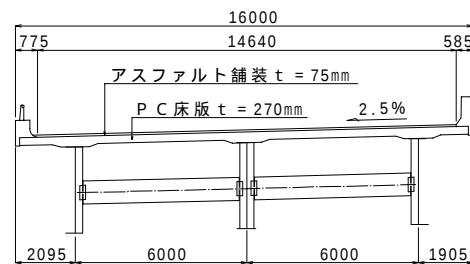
鋼少数鉋桁(3 主桁)標準断面図
